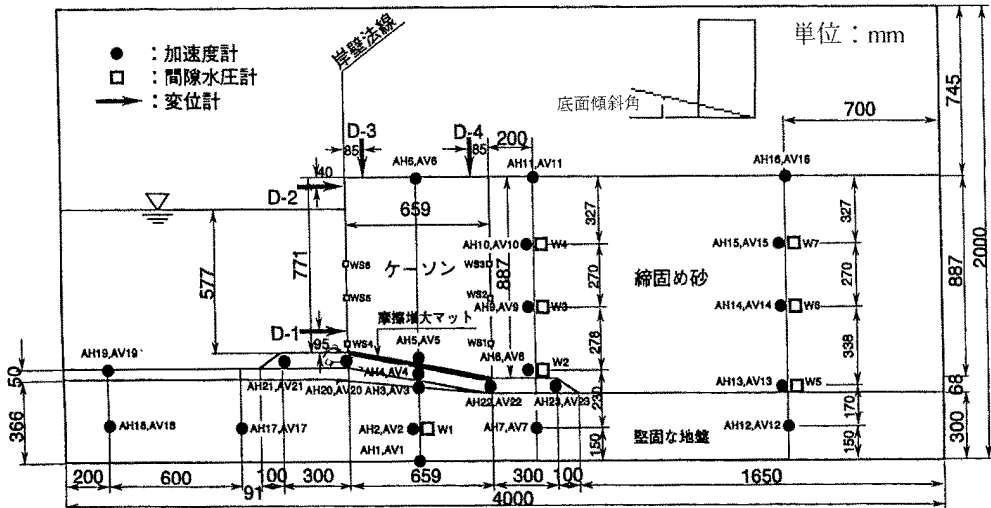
斜底面ケーソン式岸壁模型断面と計器配置状況
